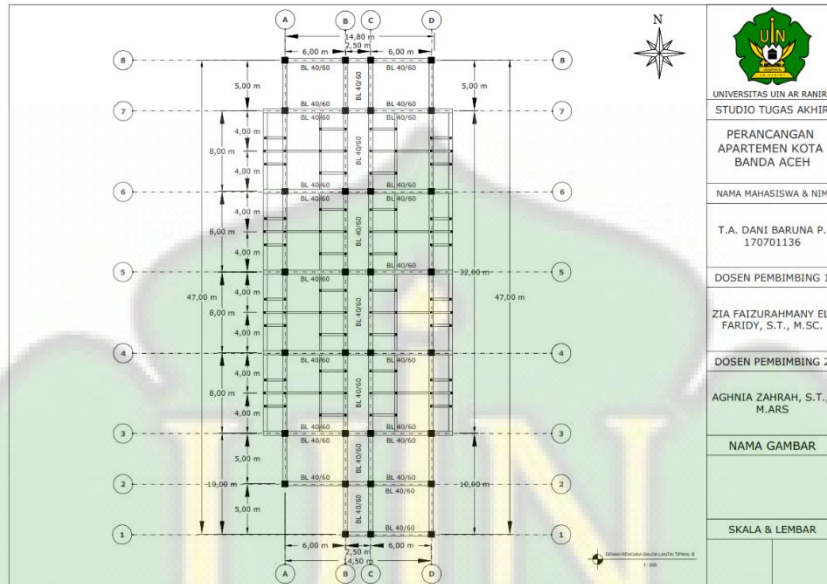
Denah Rencana Balok Lantai Dasar
